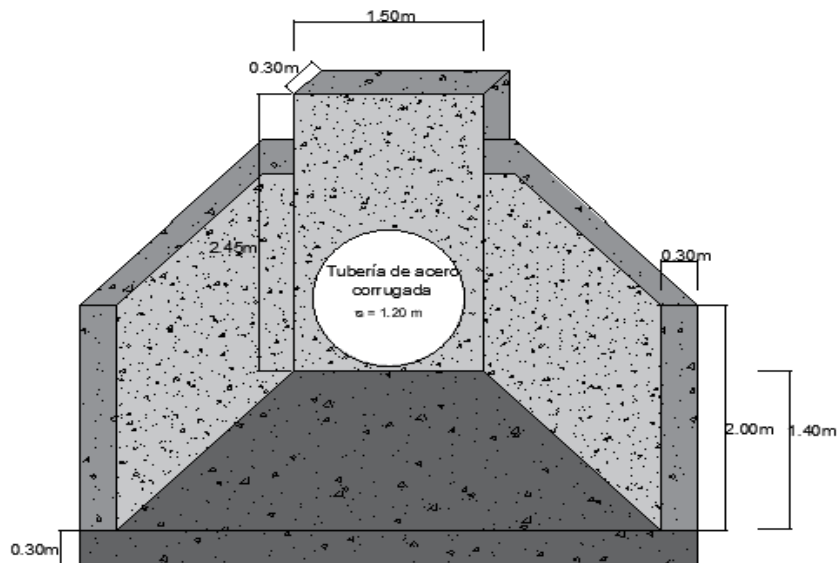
Dimensiones de alcantarilla para drenaje de calzada.
